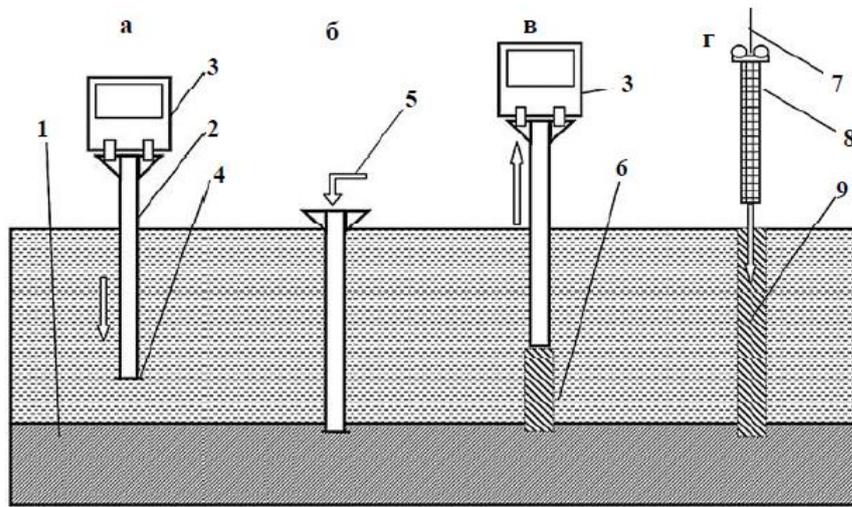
Етапи влаштування вібронабивної палі: 1 – щільний ґрунт; 2 – обсадна труба; 3 – вібрзанурювач; 4 – башмак, що втрачається; 5 – подавання бетону цебром або бетононасосом; 6 – стовбур свердловини, заповнений бетоном; 7 – вібратор на крані для занурення арматурного каркаса; 8 – арматурний каркас; 9 – палі в ґрунті
